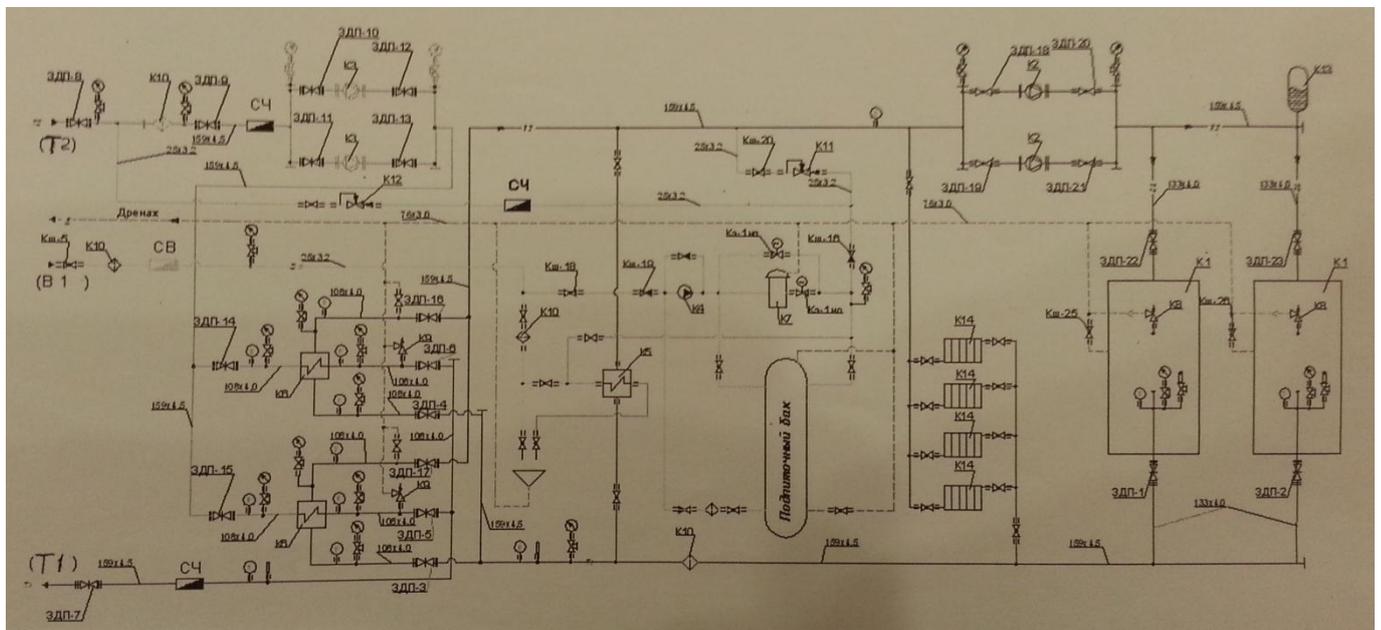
Тепловая схема котельной УКТ-2,0Т2(К) в с. Береговое
